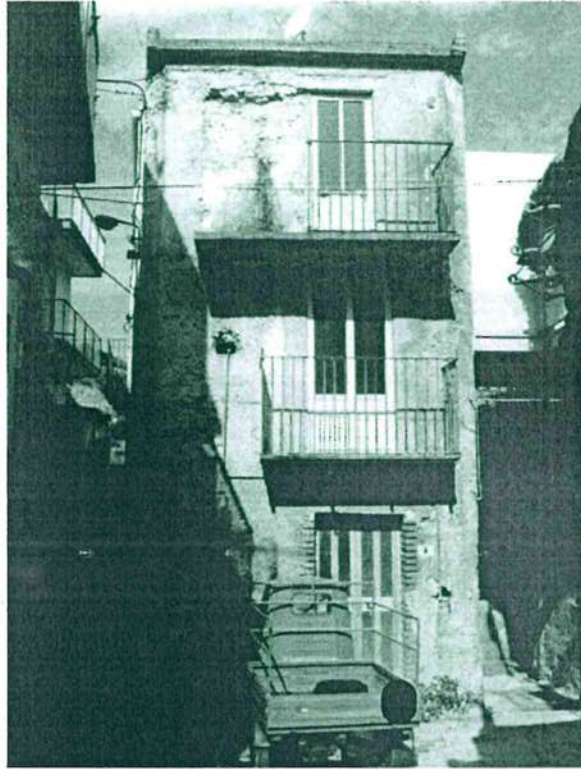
Prospetto sulla via Costa Gullo n. 8.
